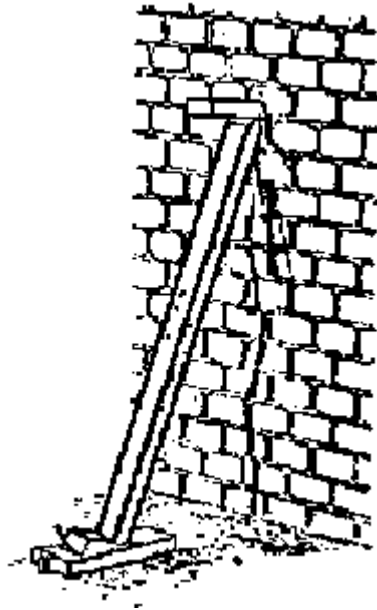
Apuntalamiento de un muro con puntal inclinado.
